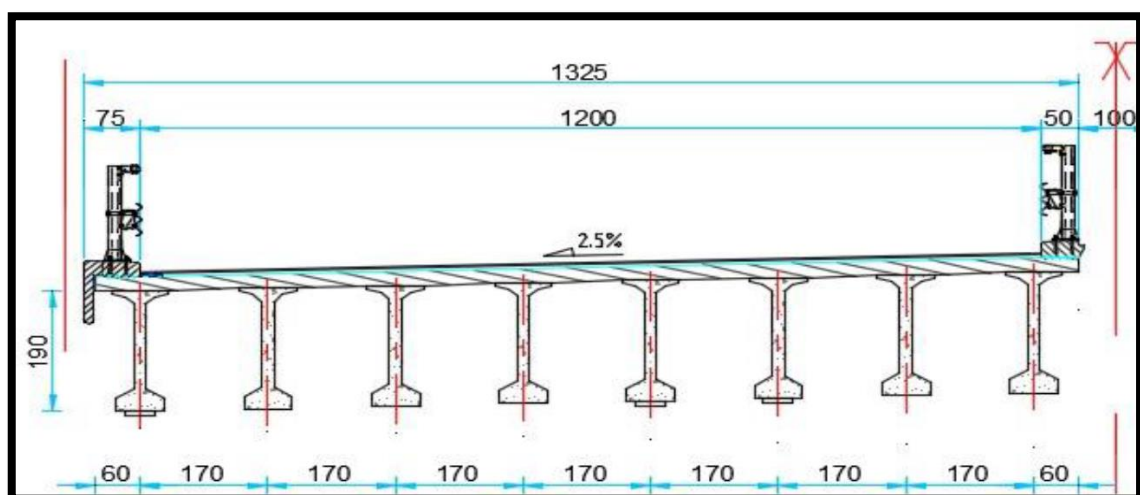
Coupe transversale sur le tablier à poutres en BP.
